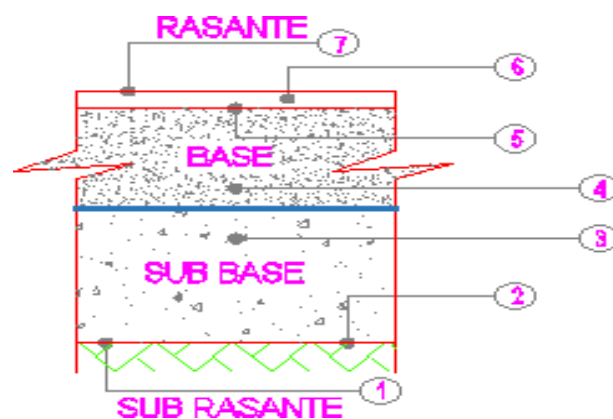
Espesores de pavimento reforzado con geomalla biaxial
